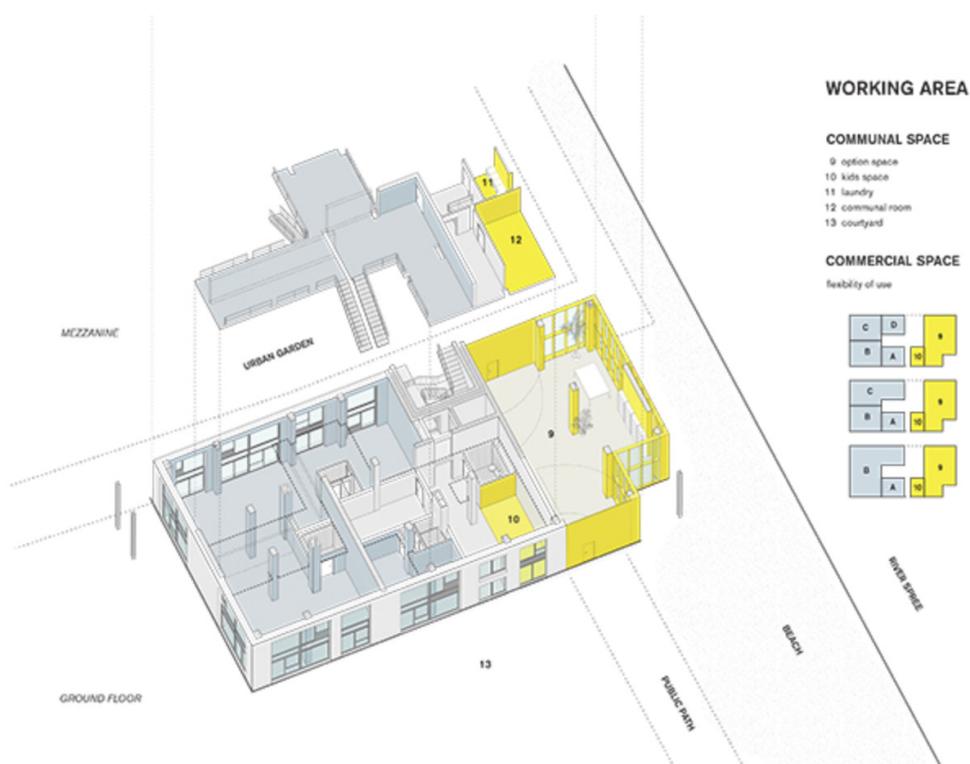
Spreefeld Berlin, Grundriss EG mit Gemeinschaftsraum
